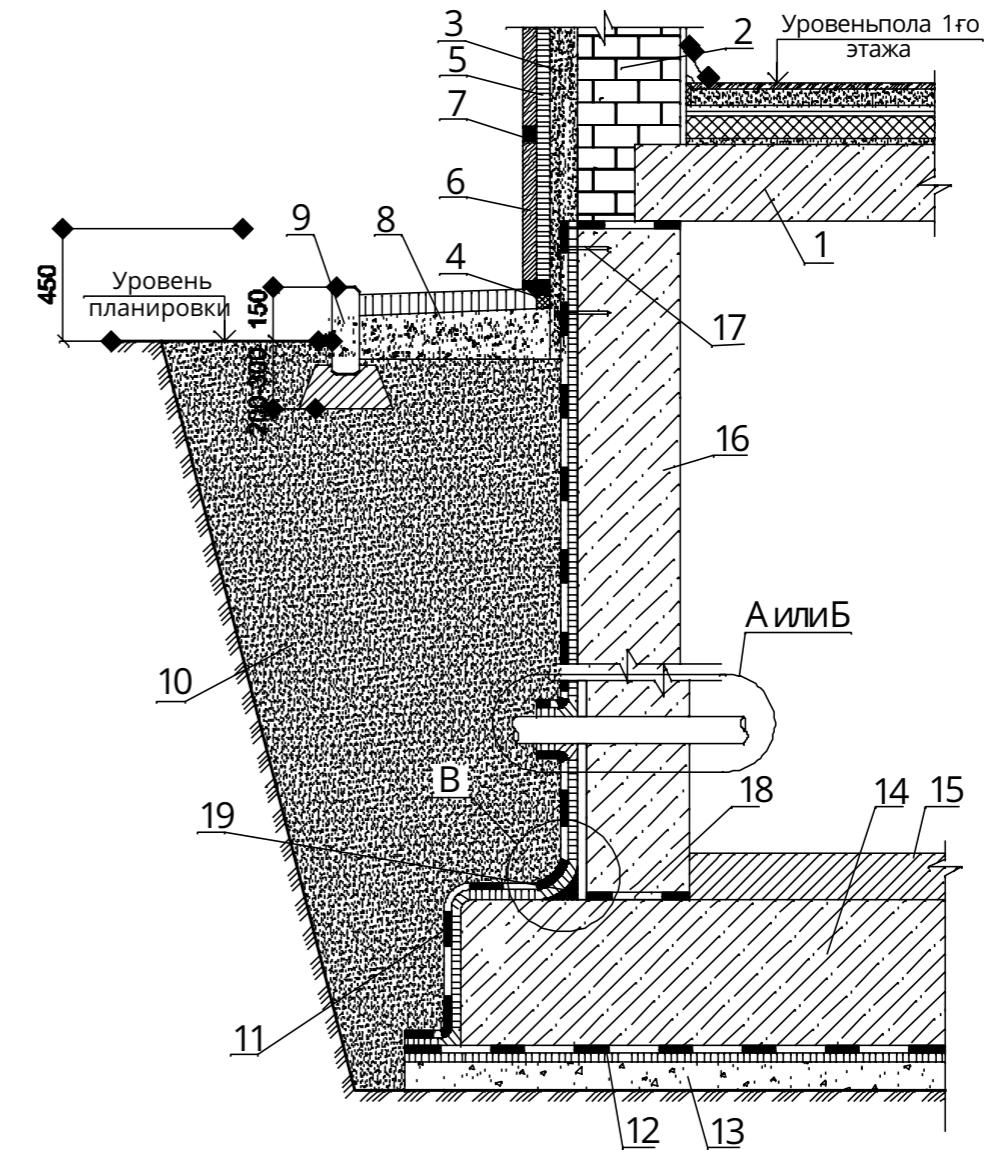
Узел 3. Гидроизоляция монолитной стены подвала и фундаментной плиты здания
